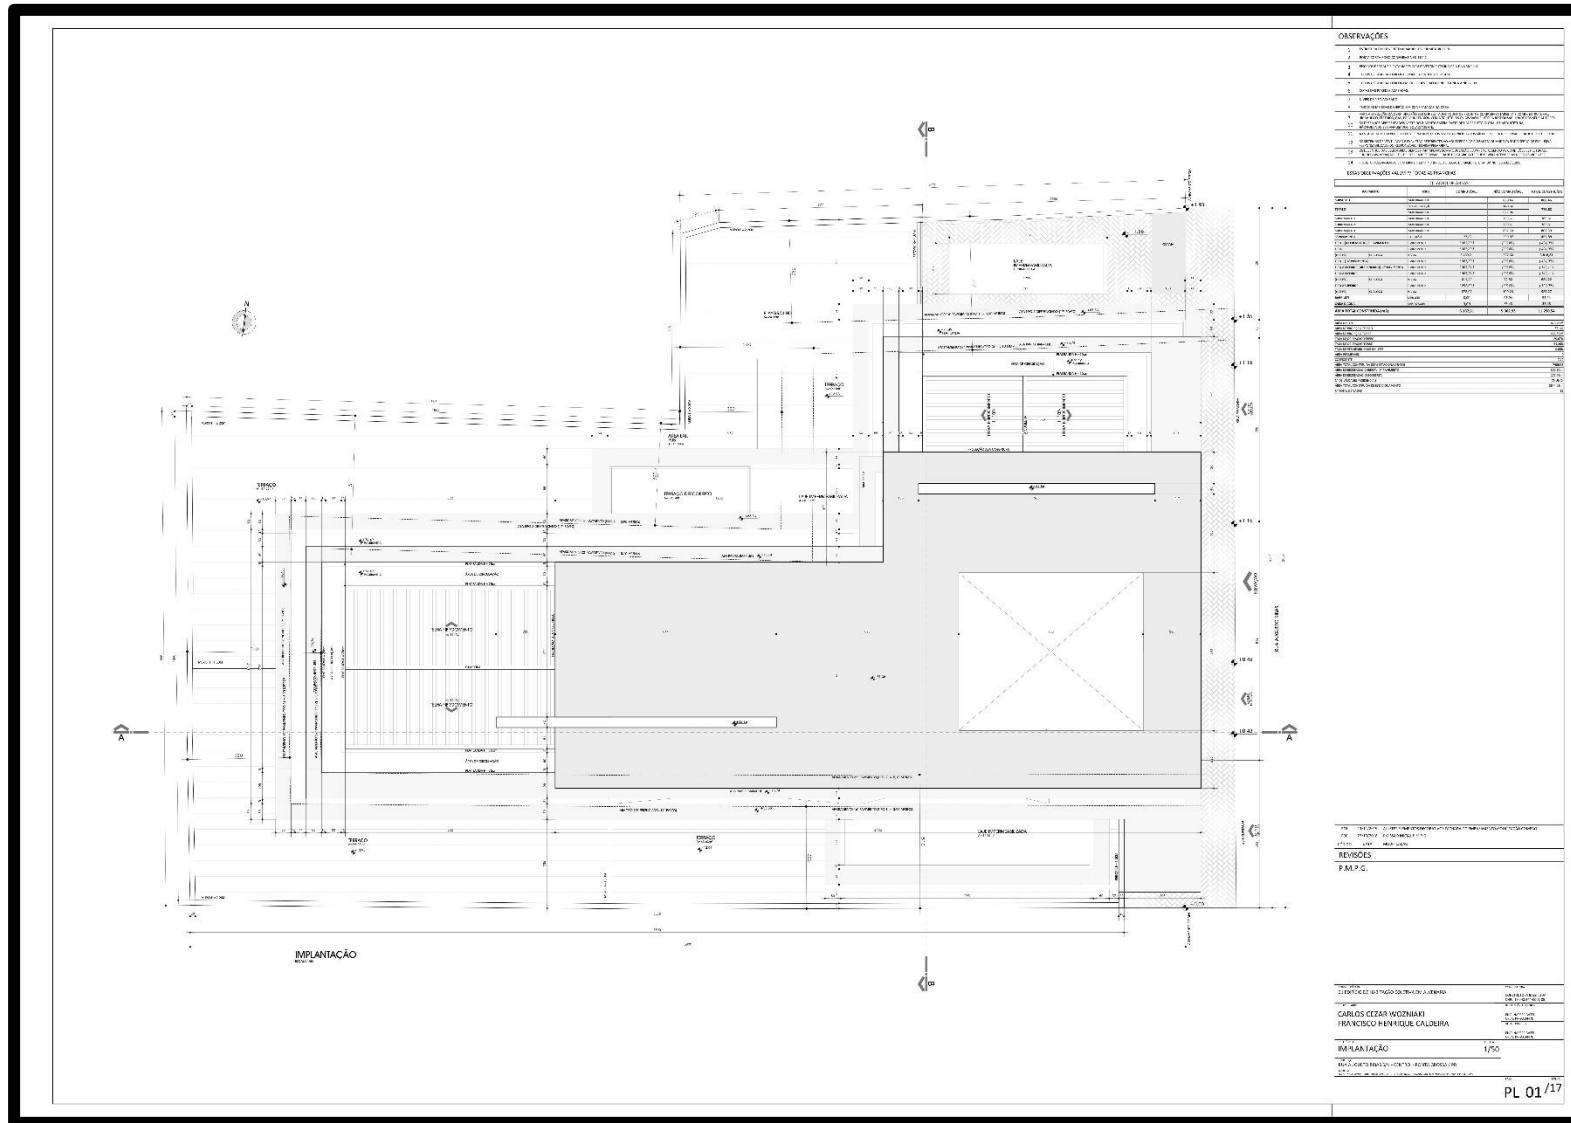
Planta de implantação. Fonte: Construtora Bazzi (2020).
